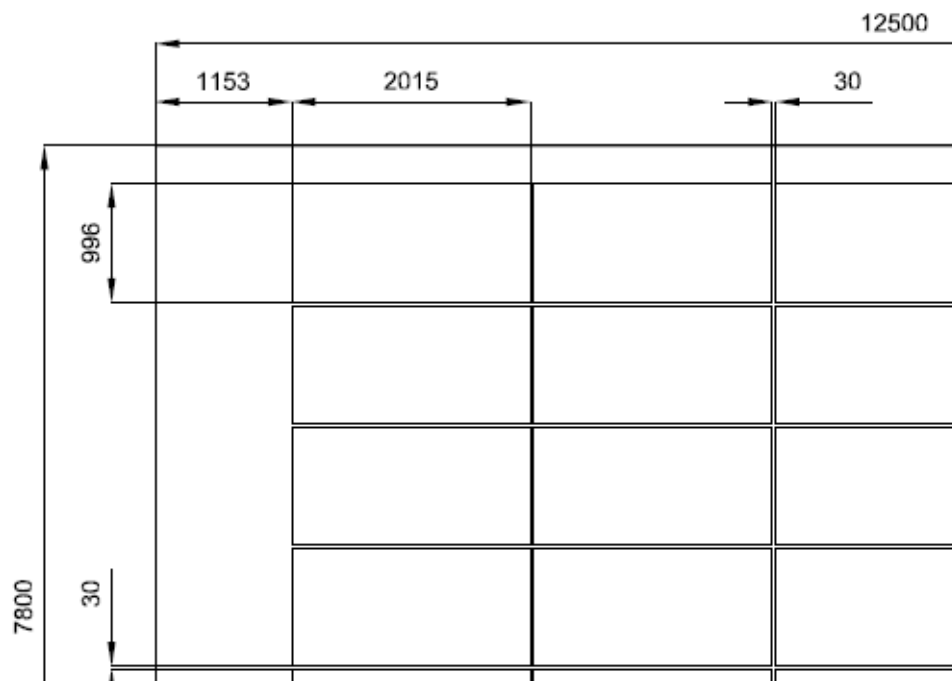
Detalle de la distribución de los paneles sobre el tejado.
